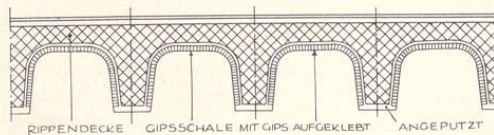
Verkleidung der Eisenbetonstegdecke mit gegossenen Gips-hohlkörpern zur Isolierung und Verhütung von Rißbildungen in der Putzdecke
